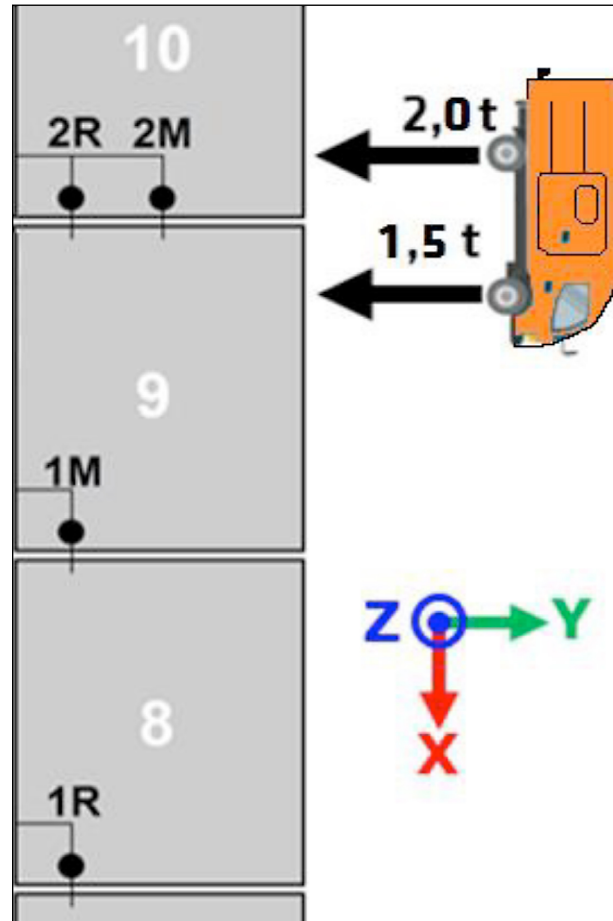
Lageplan der Sensorsysteme mit eingezeichnetem Kleintransporter und Achslasten
